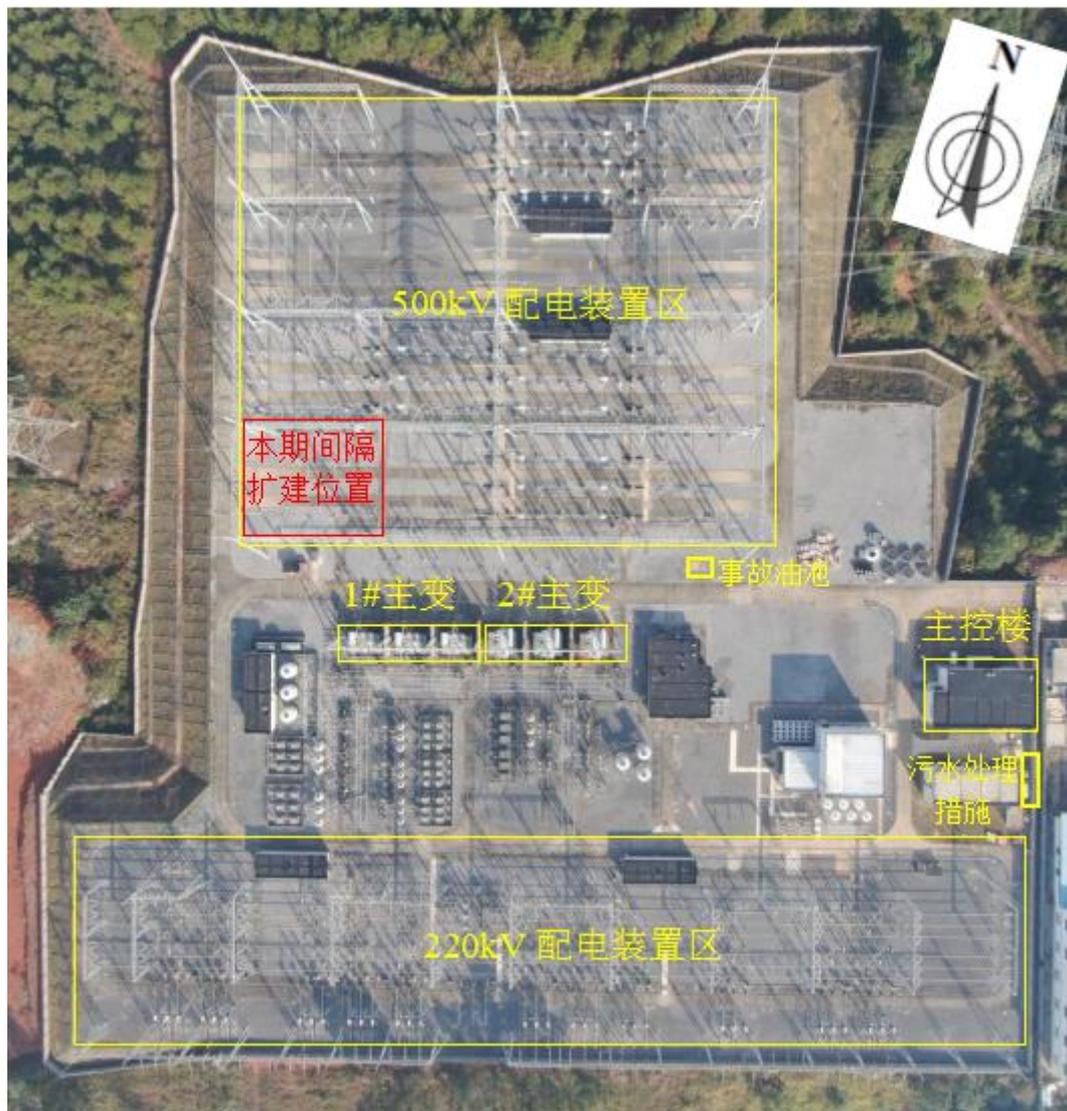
紫霞500kV变电站总平面布置及间隔扩建位置示意图
